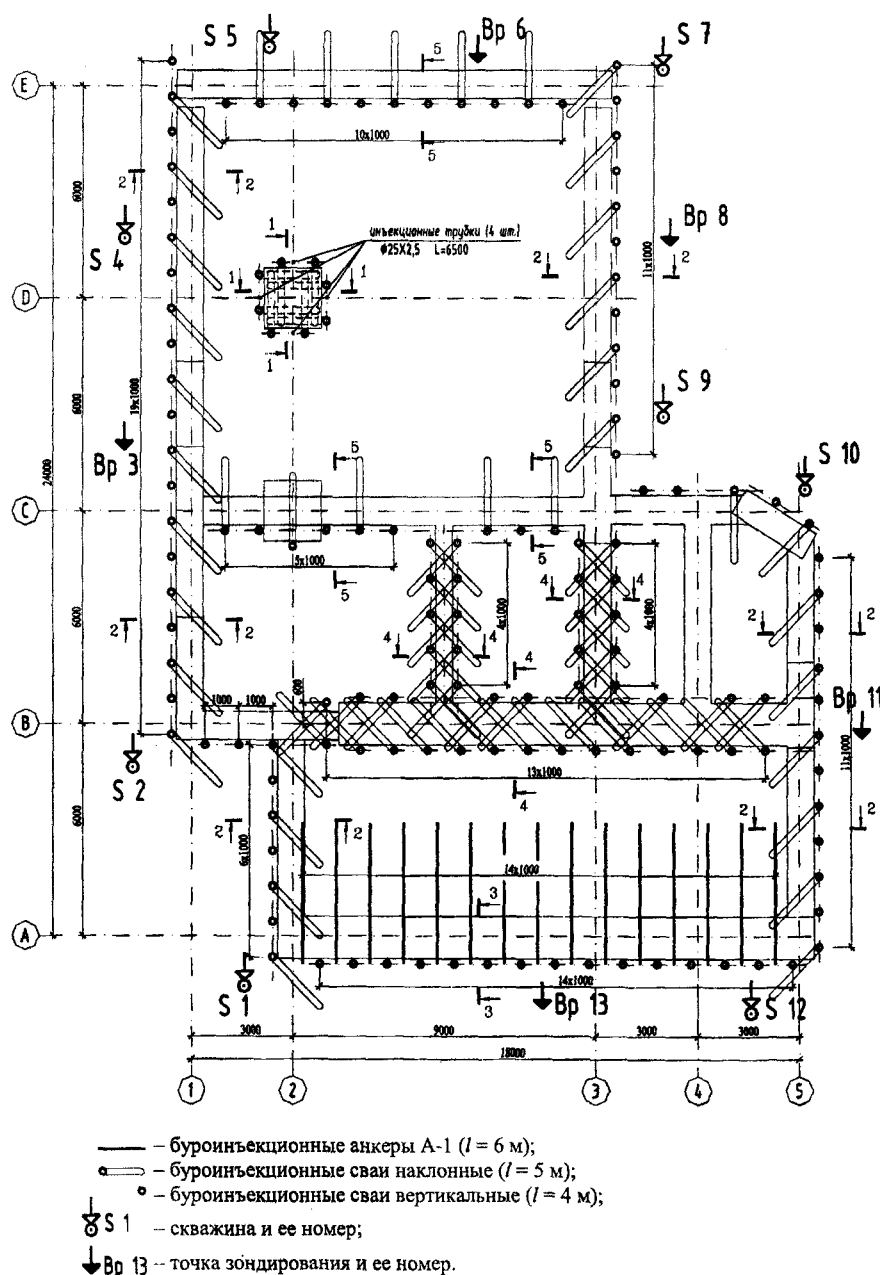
План размещения скважин и точек зондирования, буроинъекционных свай и анкеров
